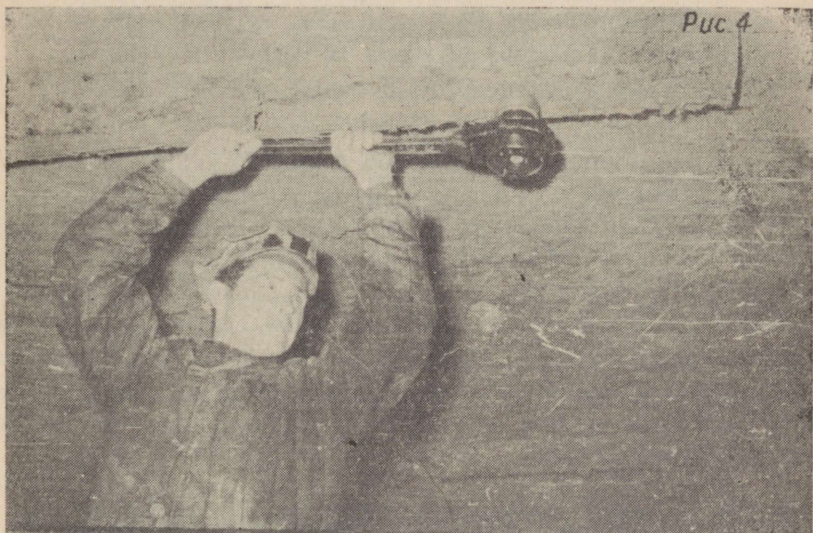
Установка штанги с помощью тарировочного ключа конструкции ИГД АН СССР.
